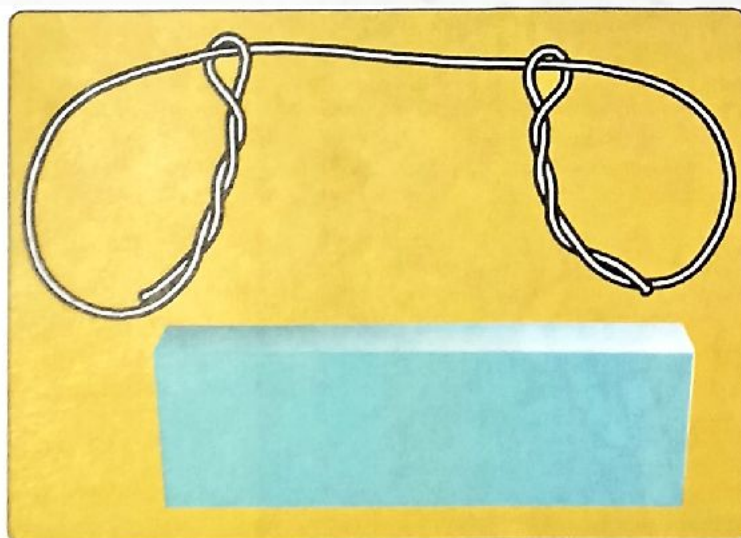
Две удавки на концах веревки в качестве захватного приспособления
